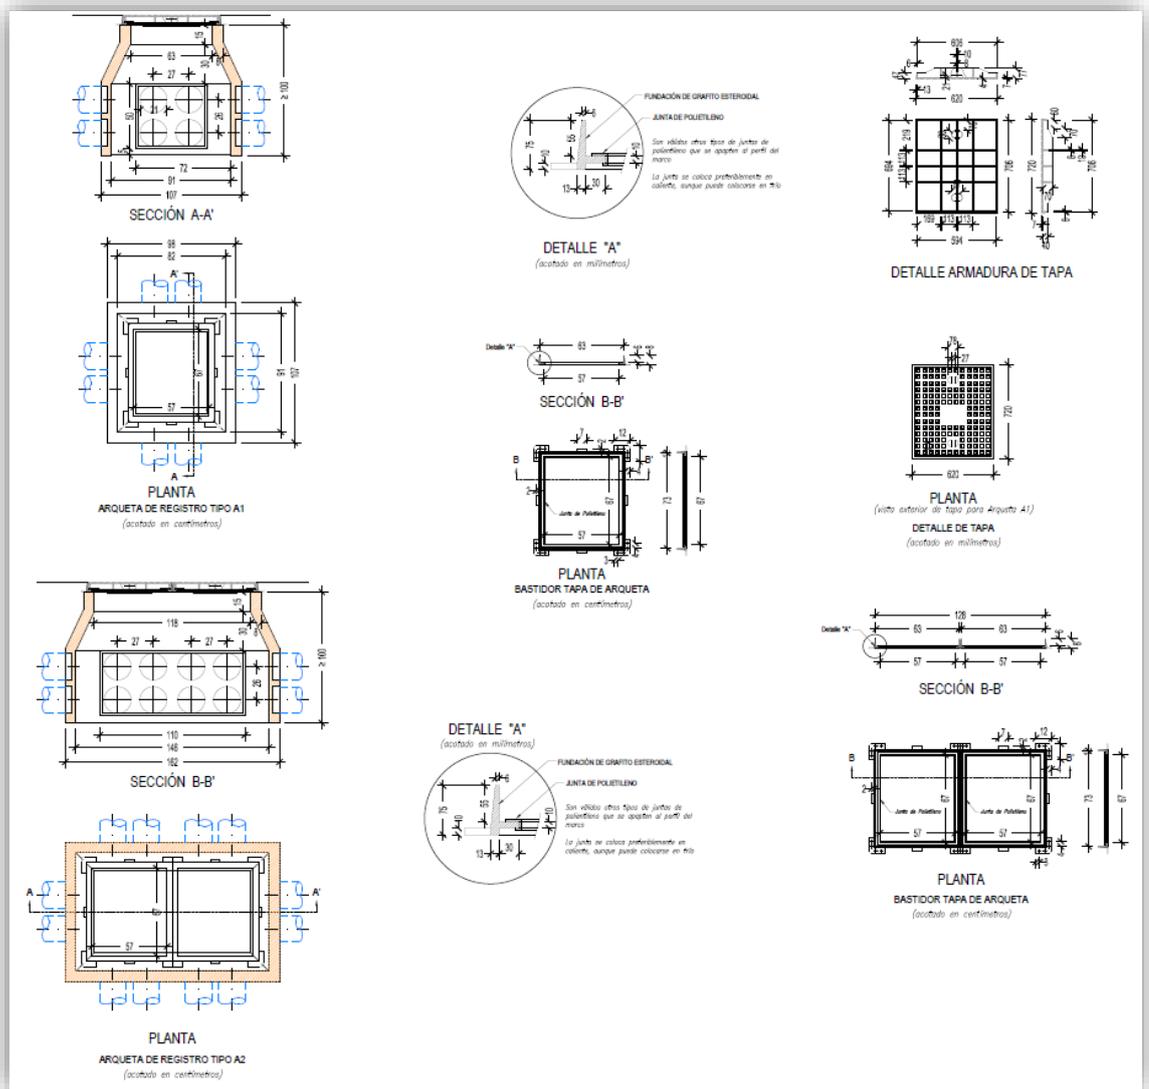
Imagen de detalle de arqueta incluida en el proyecto.
